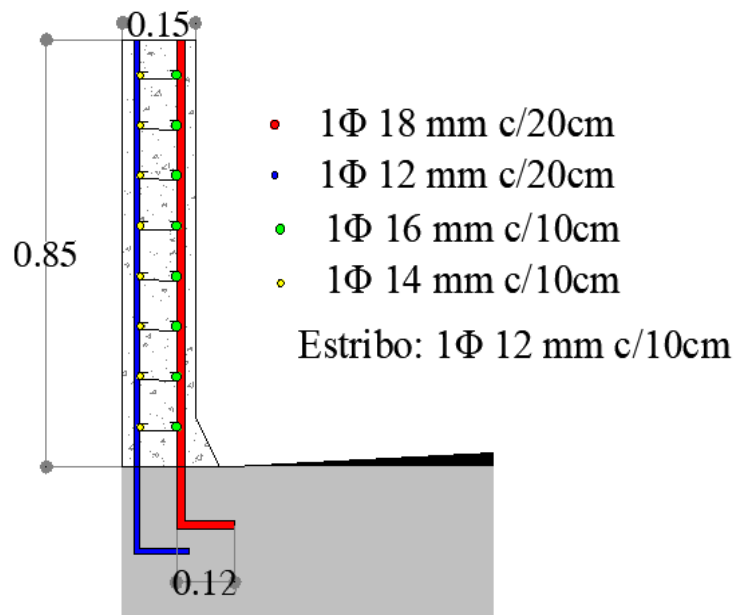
Diseño final de la protección lateral de hormigón armado (maciza)
